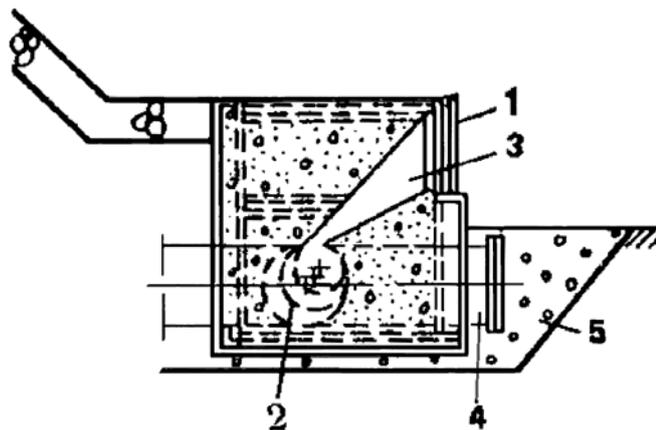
Бетонный в стальной оболочке водоприемник с вихревой камерой и односторонним отбором воды
